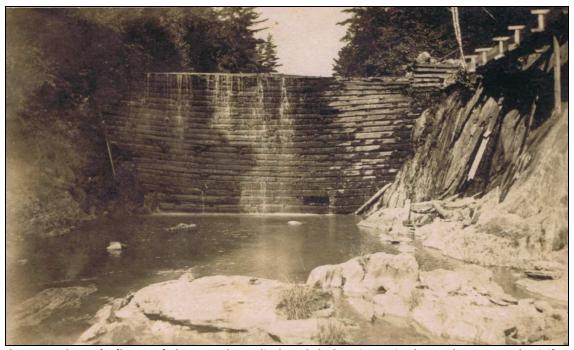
Chaussée (barrage) du second moulin banal de la seigneurie de Taschereau sur la rivière Chassé, à Sainte-Marie, vers 1920
